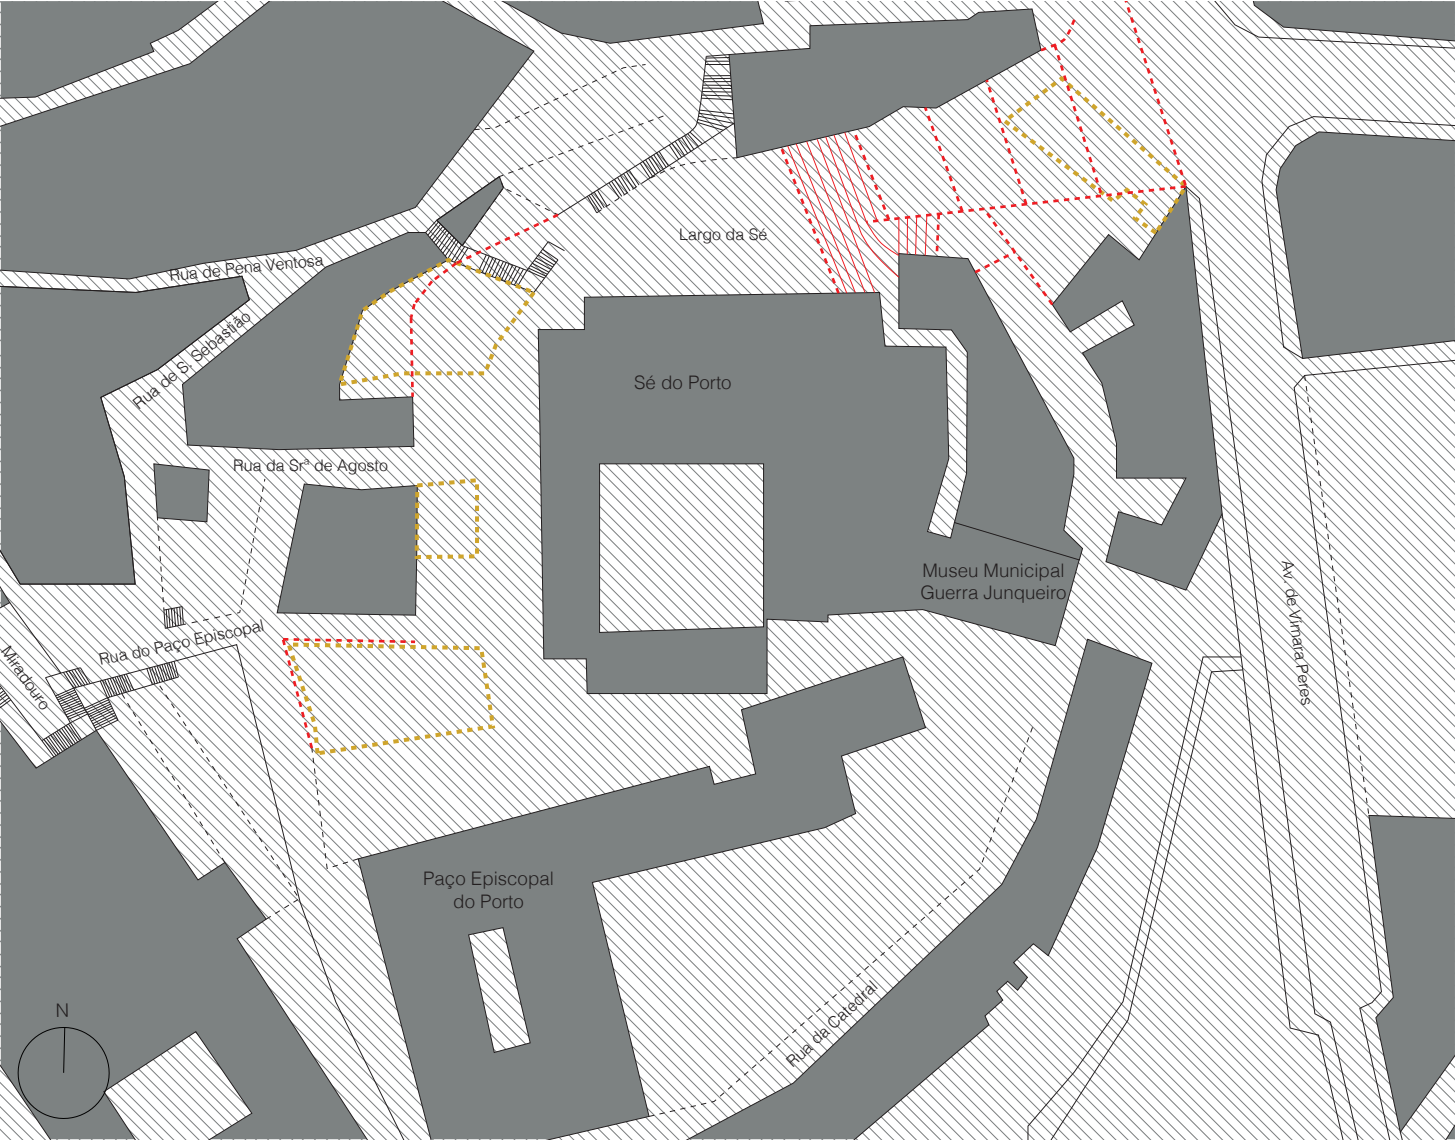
Planta esquemática do tipo cheio/vazio, correspondente à primeira proposta.
